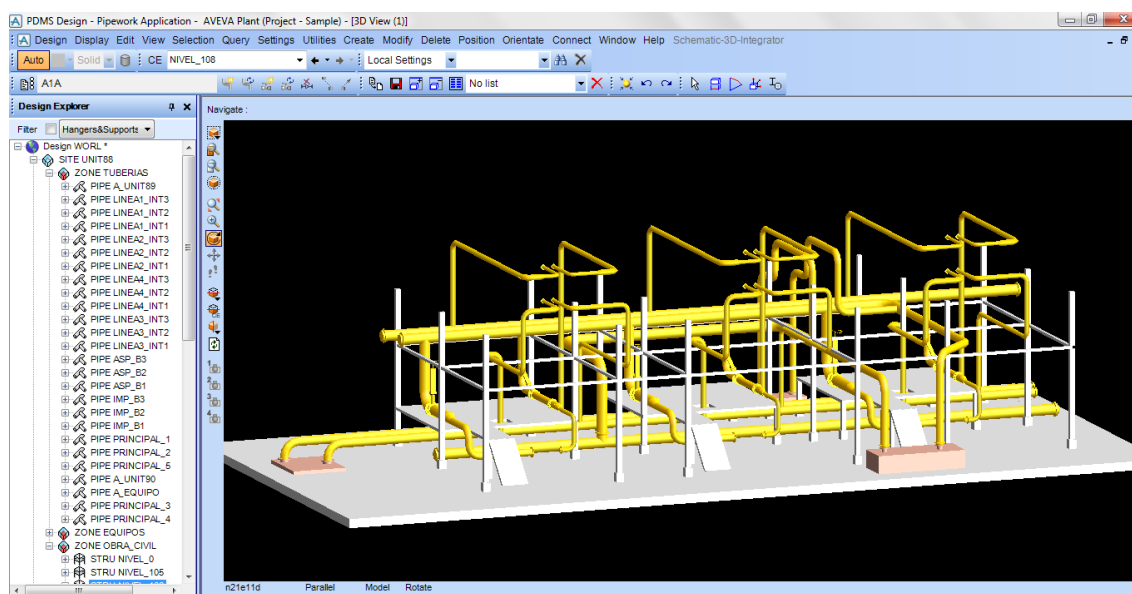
Vista frontal del conjunto de líneas sin el nivel superior.
